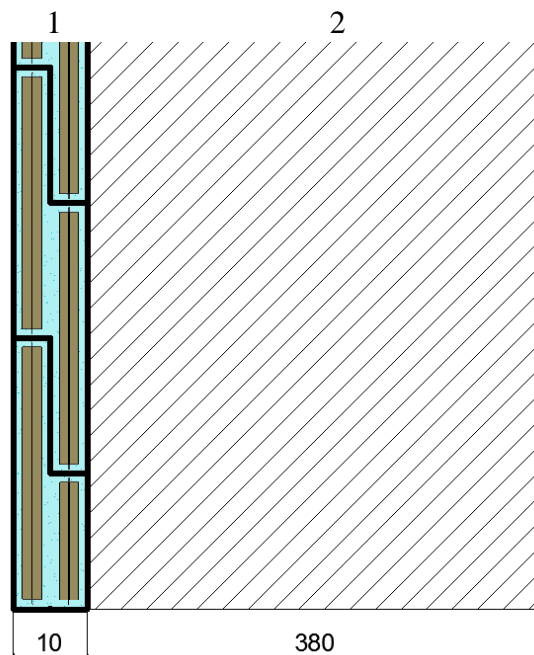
Стіна утеплена плиткою з невентильованими повітряний прошарками
